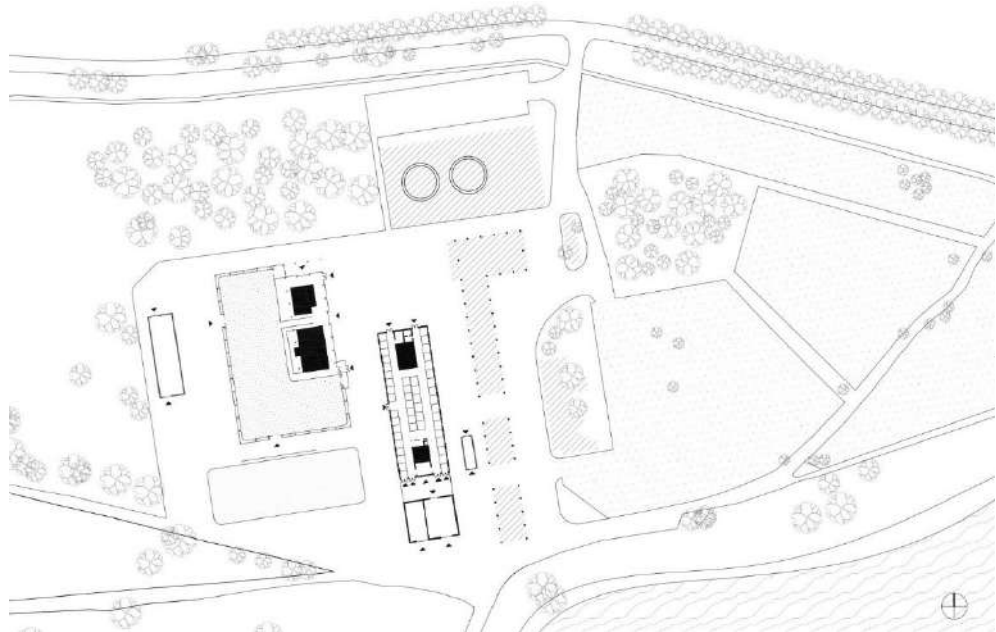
Генеральний план Klagshamn's Equestrian Center [24]
